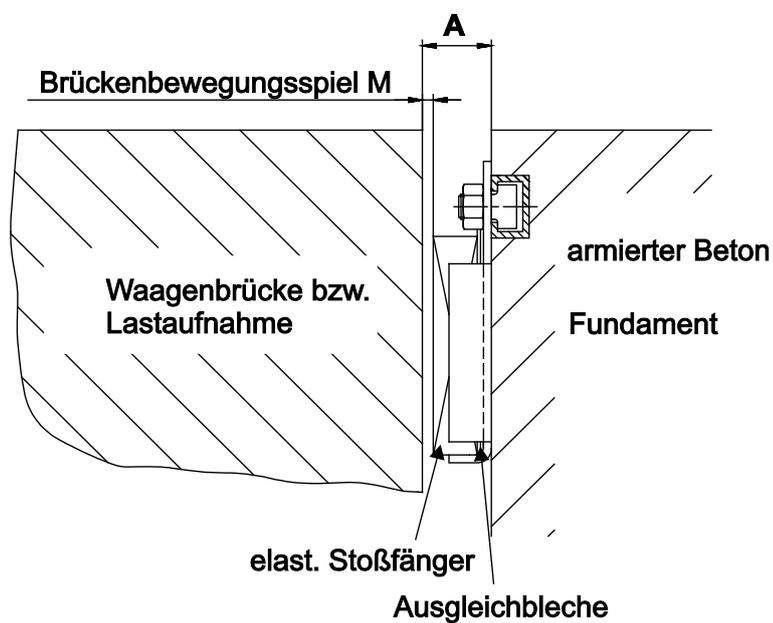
Einsatz des elastischen Stoßfängers DES in einer Betonkonstruktion (z. B. bei Straßenfahrzeugwaagen)
